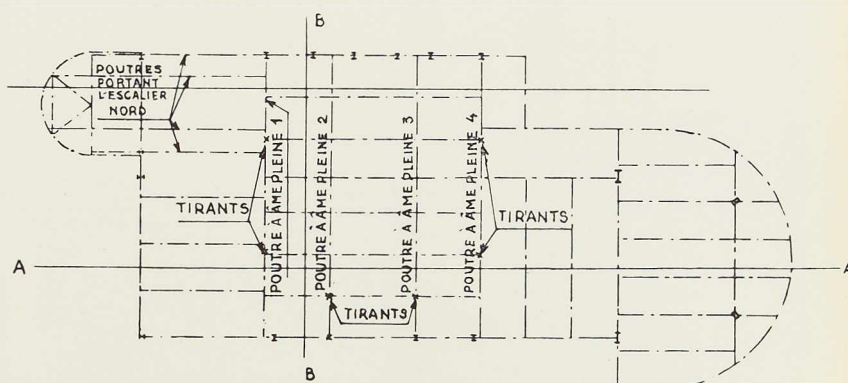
Plan de l'ossature métallique du hall au niveau de la toiture.
